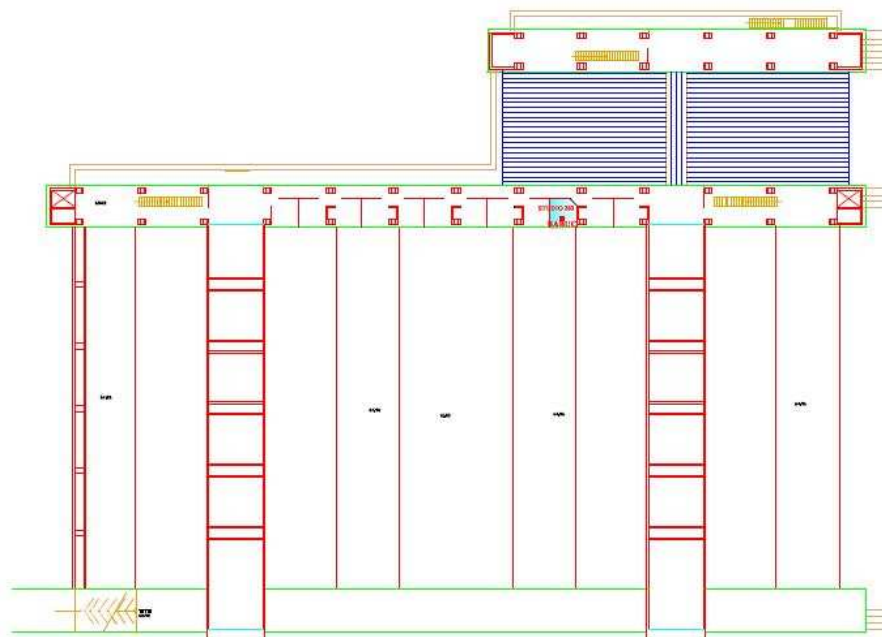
Edificio 18, collocazione in pianta dello Studio n°203
